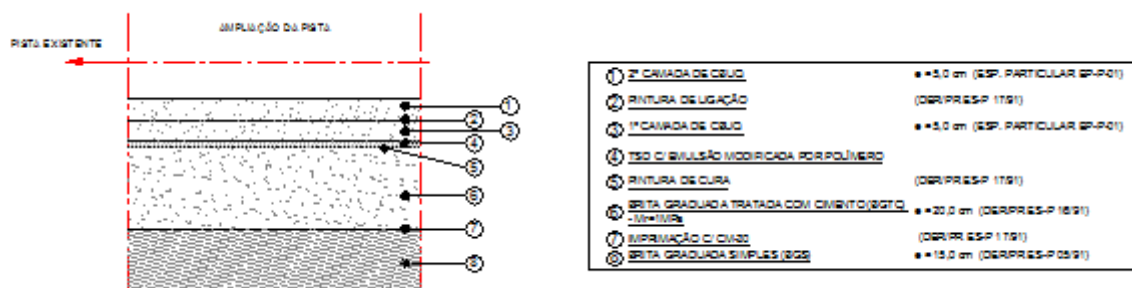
Solução de Pavimento Semirrígido (Pista a Implantar)
